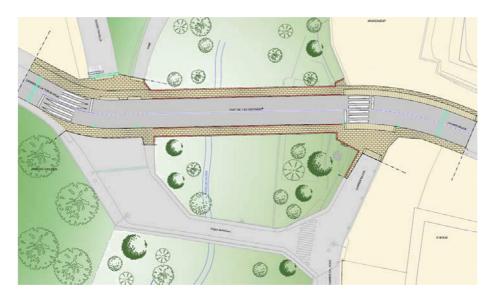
Planta general. Puente de Les Cremades construido y Románico sin rehabilitar.
